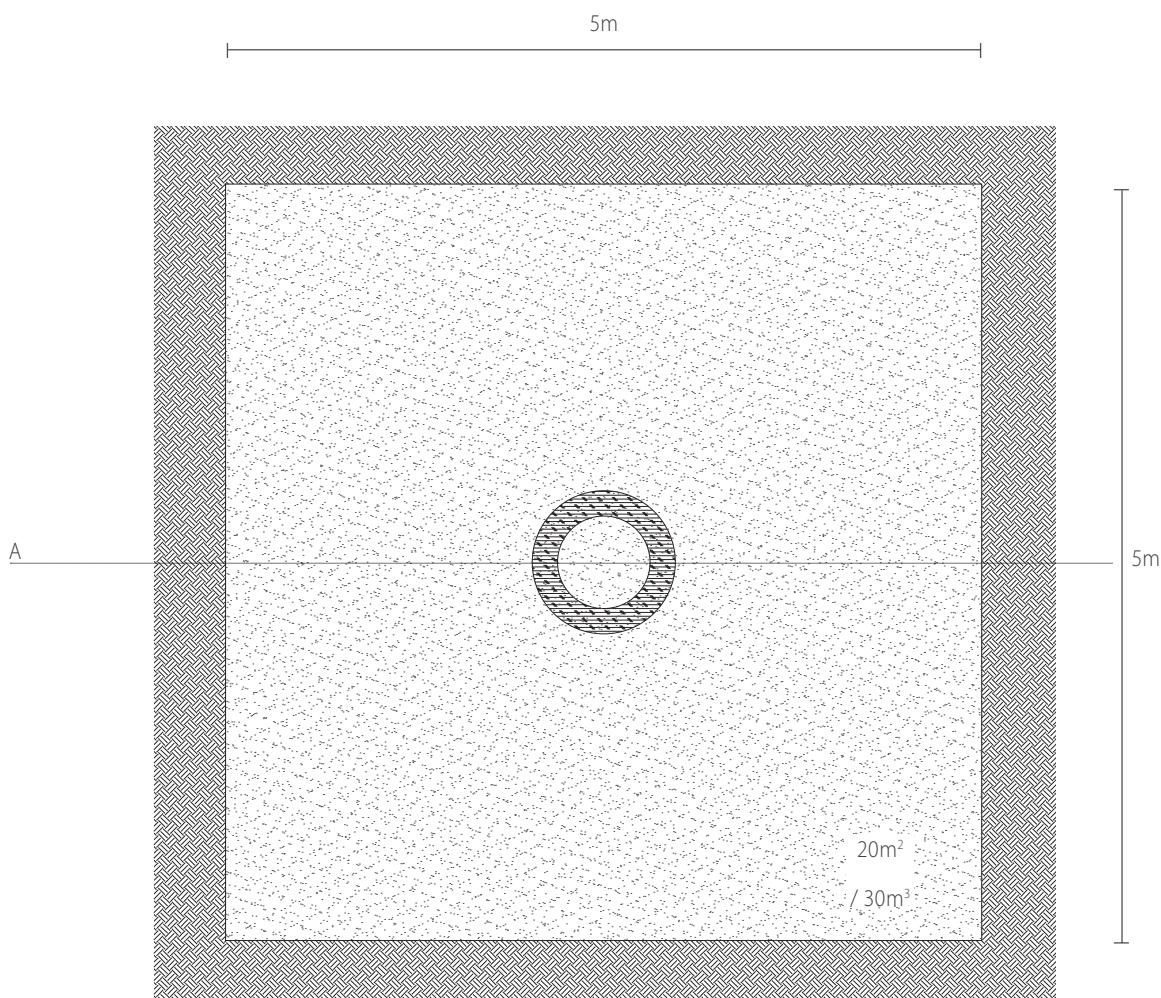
Detailansicht Bauweise 1: Draufsicht
